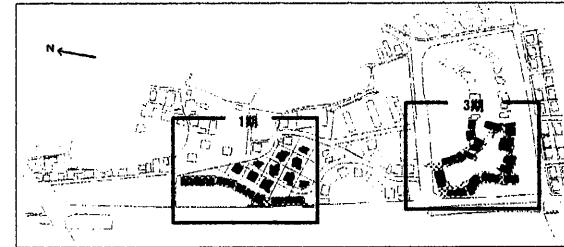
(建替後) 中庄団地住棟配置図 1:10000
